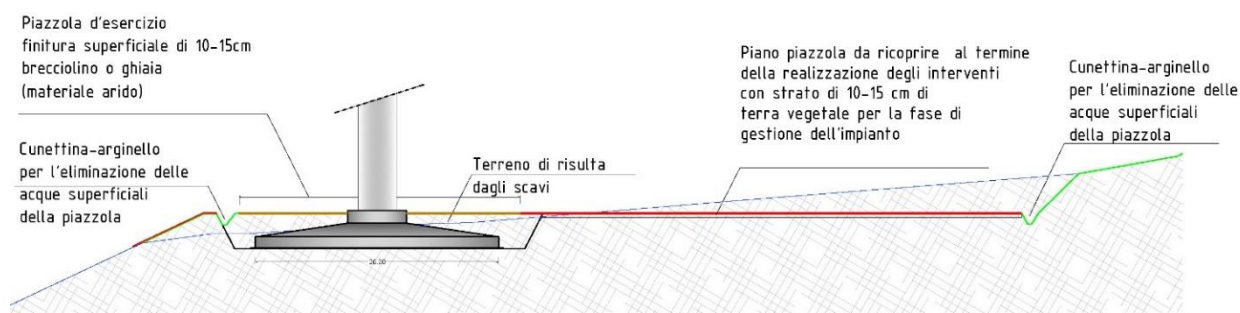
SISTEMAZIONE FINALE PIANO PIAZZOLA
